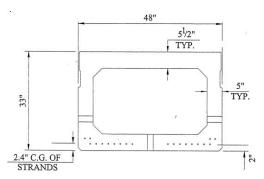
1—Sección transversal de viga tipo caja
